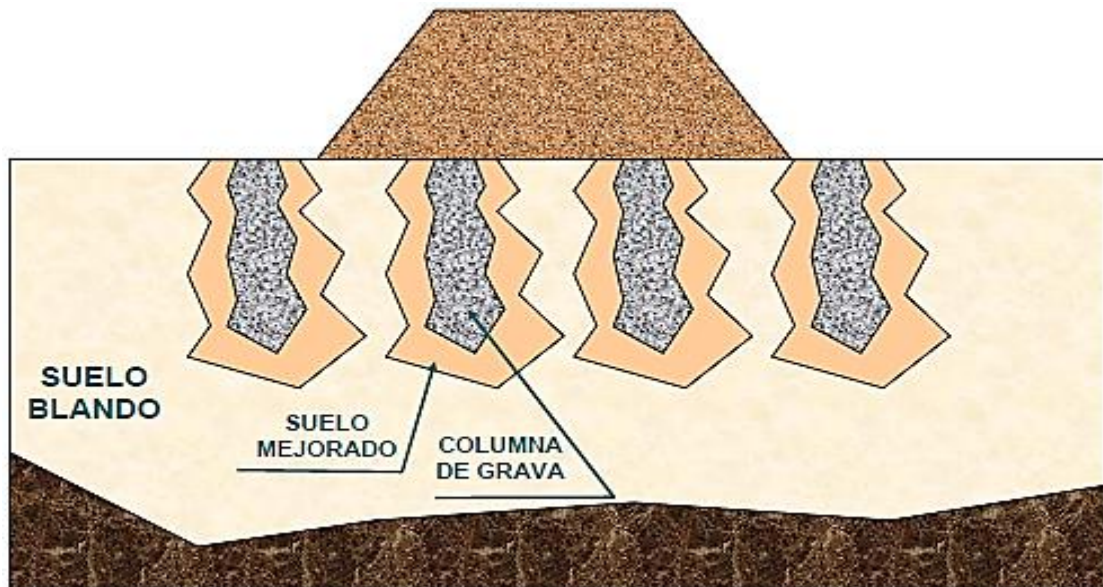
Mejora con columnas de grava. Mejora del terreno. Obras geotécnicas. Universidad de Sevilla.
